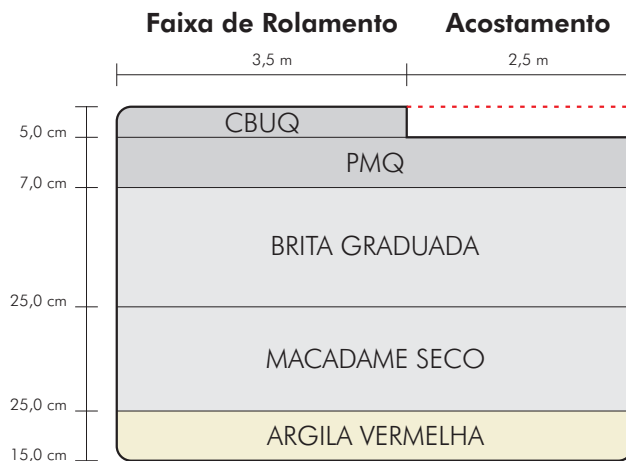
Perfil do Pavimento do Acesso a Chapecó/SC.
